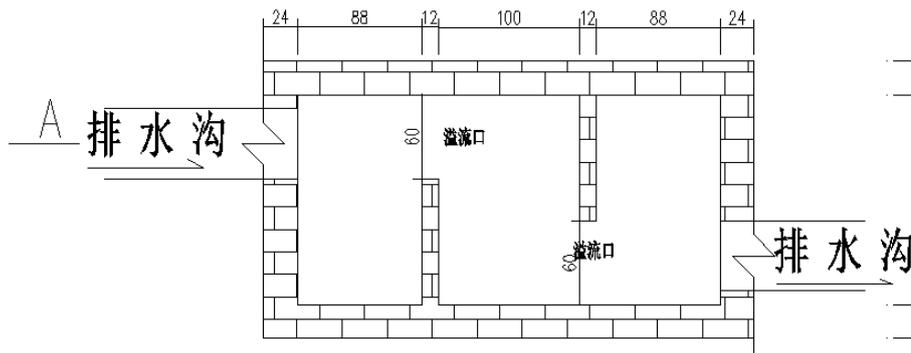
风电机场沉沙池典型断面图（单位:mm）
